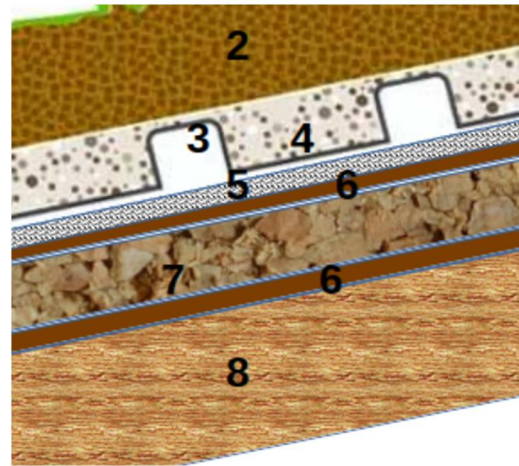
Cuberta verde. 1. Vexetación (verde); 2. Terra; 3. Lámina nodular drenante de PE; 4. Recheo grava e area; 5. Capa xeotéxtil de protección e impermeabilización; 6. Taboleiro de madeira OSB; 7. Cortiza; 8. Viga laminada estrutural.
